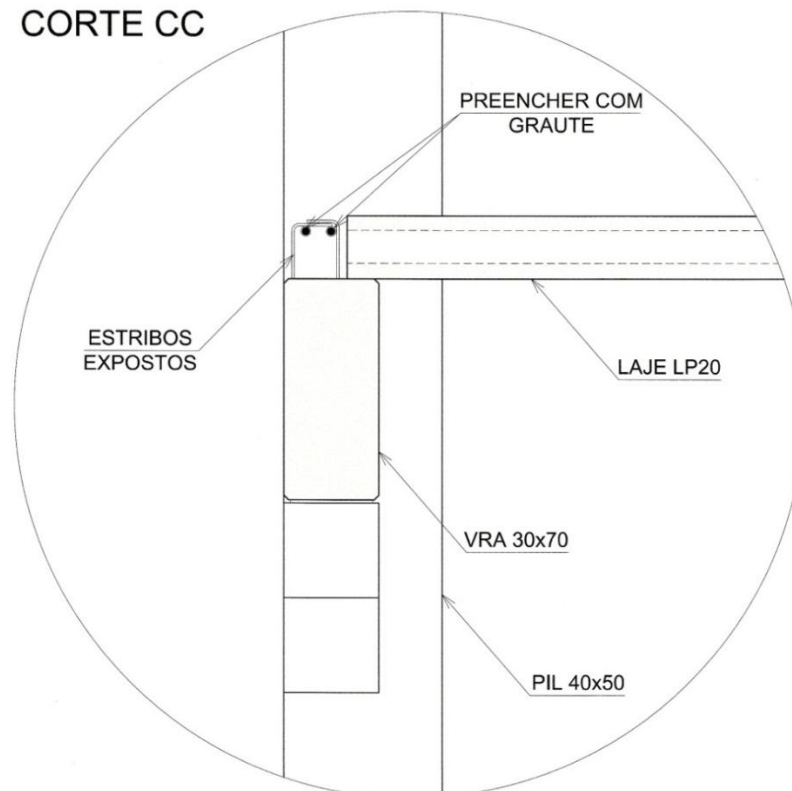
18 – Corte CC indicando a necessidade de preenchimento com graute das bainhas metálicas (após inserção das barras do tirante).
